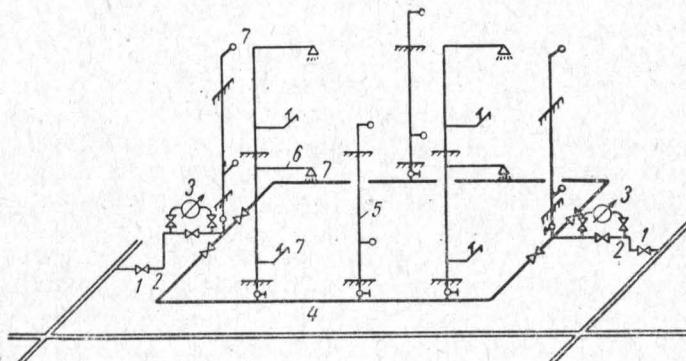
Схема внутренней водопроводной сети с нижней разводкой.
